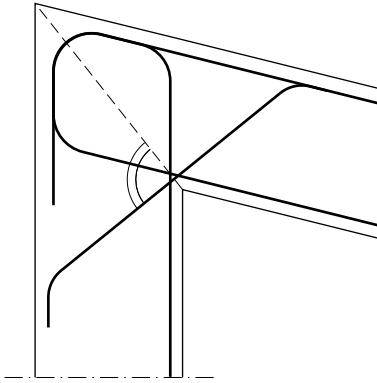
Bewehrungsführung bei einer Rahmenecke mit spitzem Winkel
